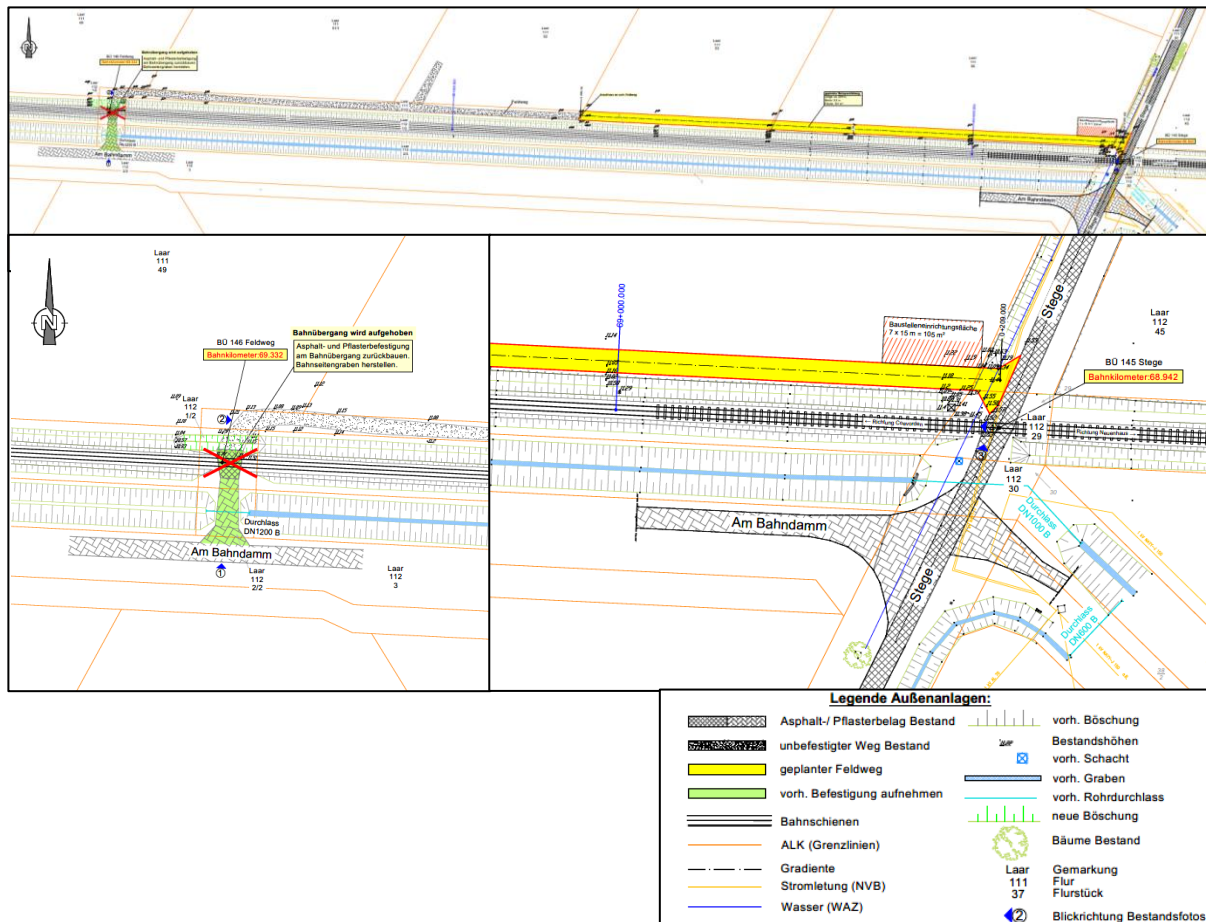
Planung Rückbau des Bahnübergangs 146 Feldweg und Bau eines Parallelweges (Ausschnitte aus: Ingenieur- und Planungsbüro A. Sommerfeld 2024)
